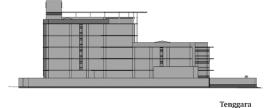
Blok Massa bangunan Sumber: Penulis, 2020.
